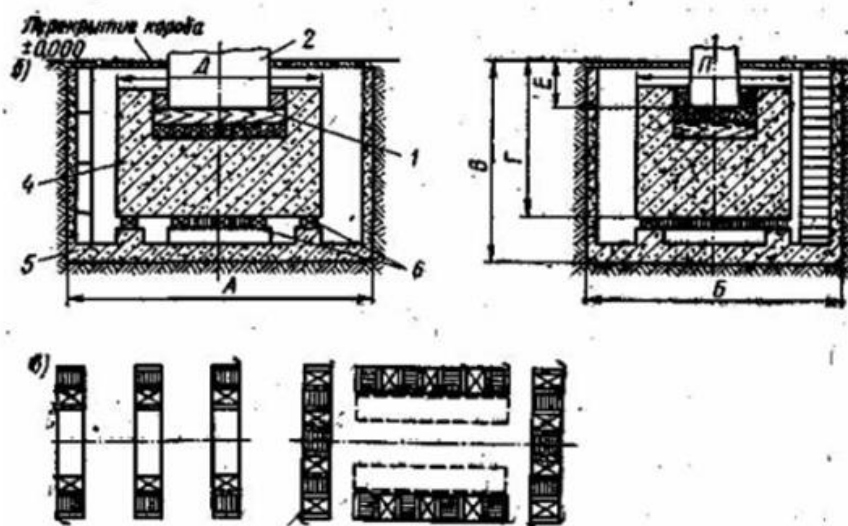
Схемы фундаментов под паровоздушные штамповочные молоты[13]: б-виброизолированный фундамент, в-расположение виброизоляторов; 1-подшаботная прокладка, 2-шабот, 3- железобетон; 4- фундаментный блок; 5 – подфундаментный короб, 6-виброизоляторы.
